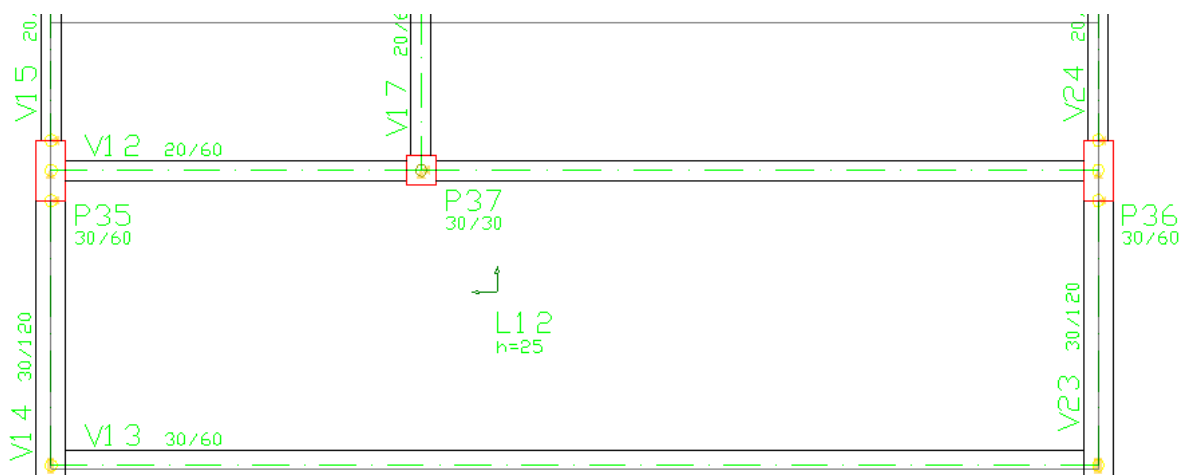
Pavimento Biblioteca da Solução Convencional com as vigas V14 e V23 de menor comprimento e maior altura
